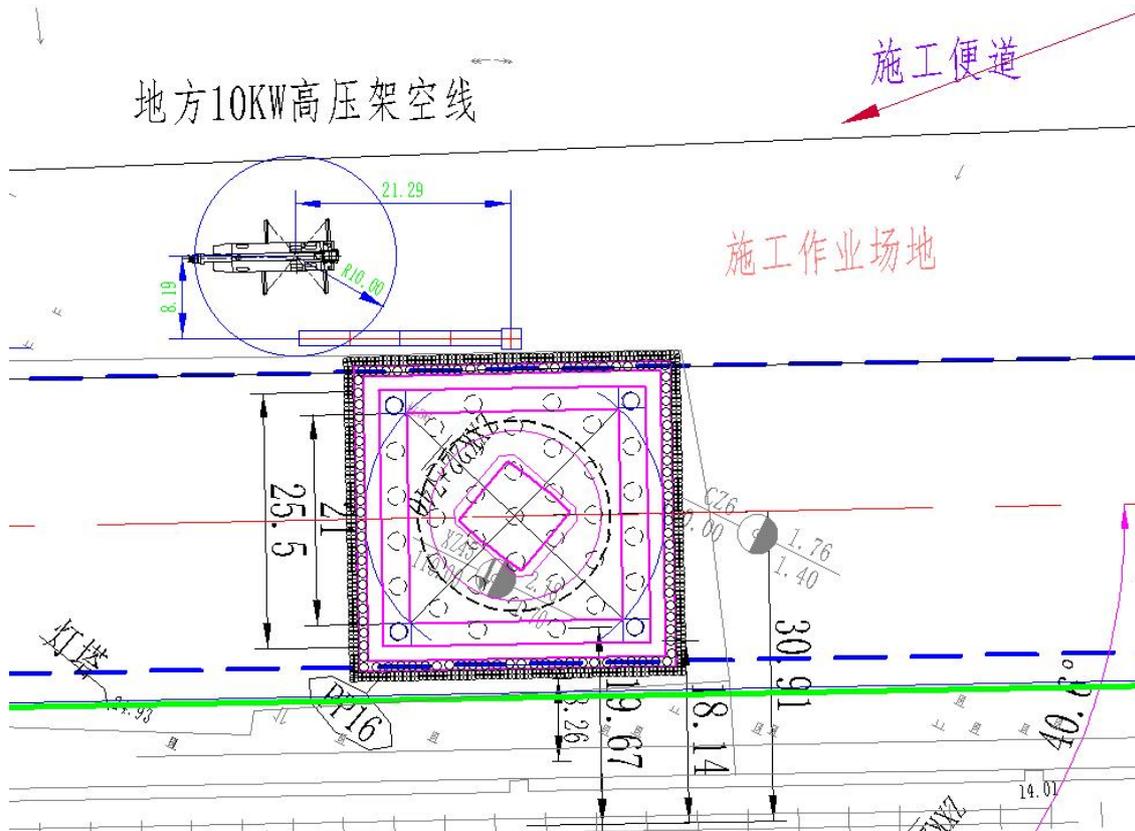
起重臂臂节二拆除平面图 (单位: m)
